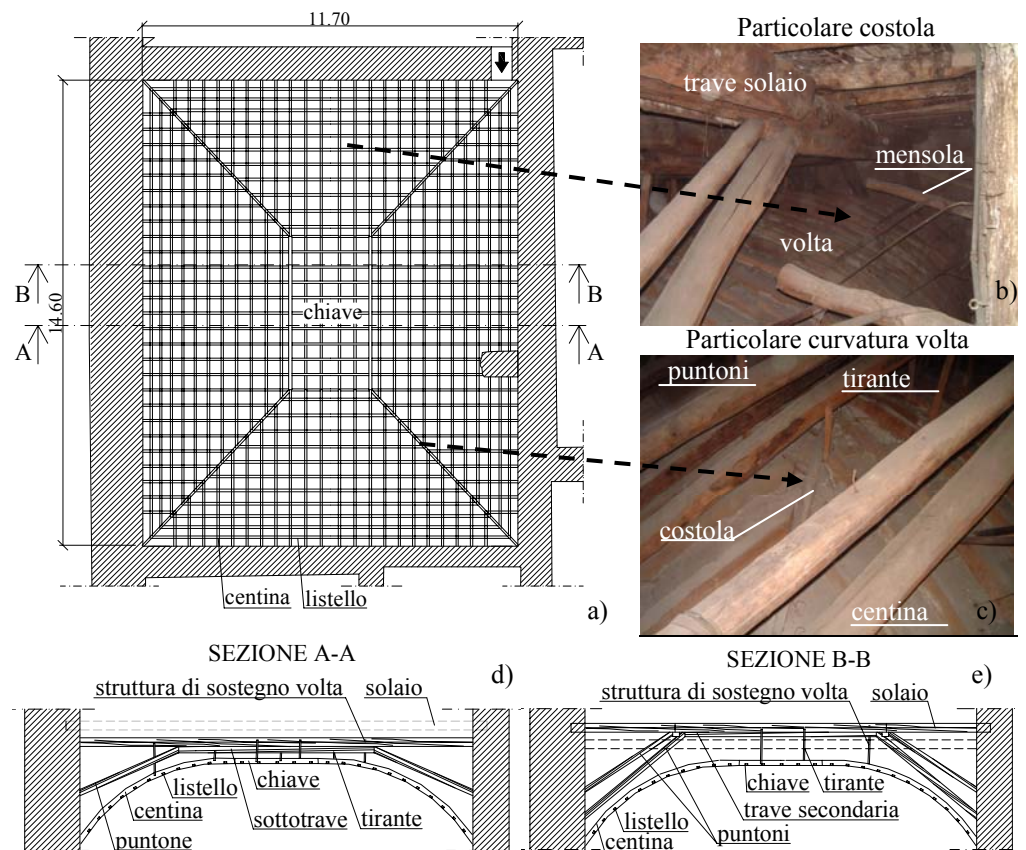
Volta: a) Carpenteria; b,c) Particolari; c) Sezione A-A; d) Sezione B-B.
